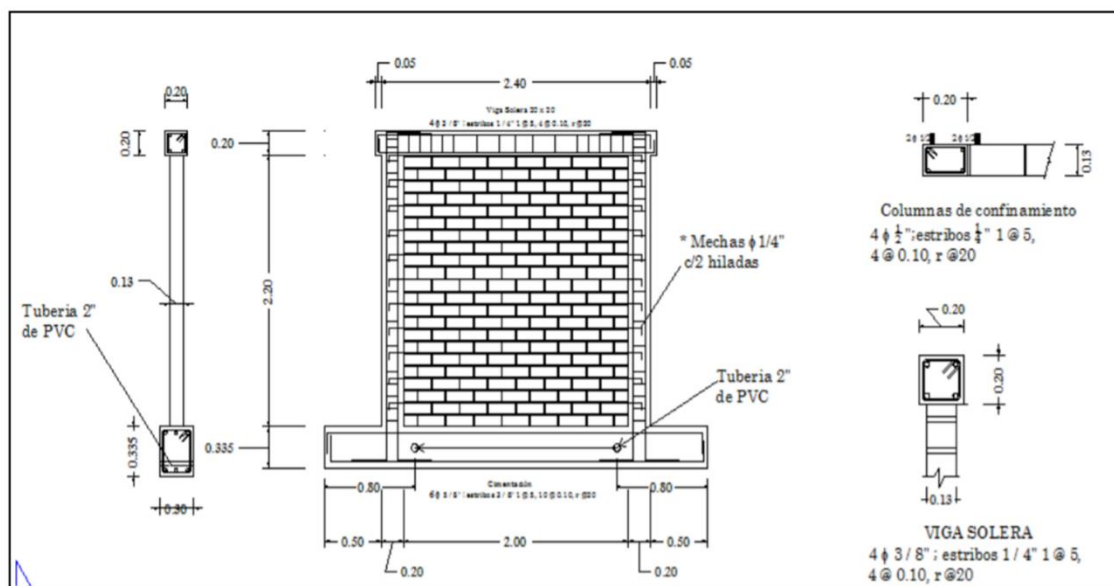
Detalle del Muro M1 de peralte de columnas de 20cm
